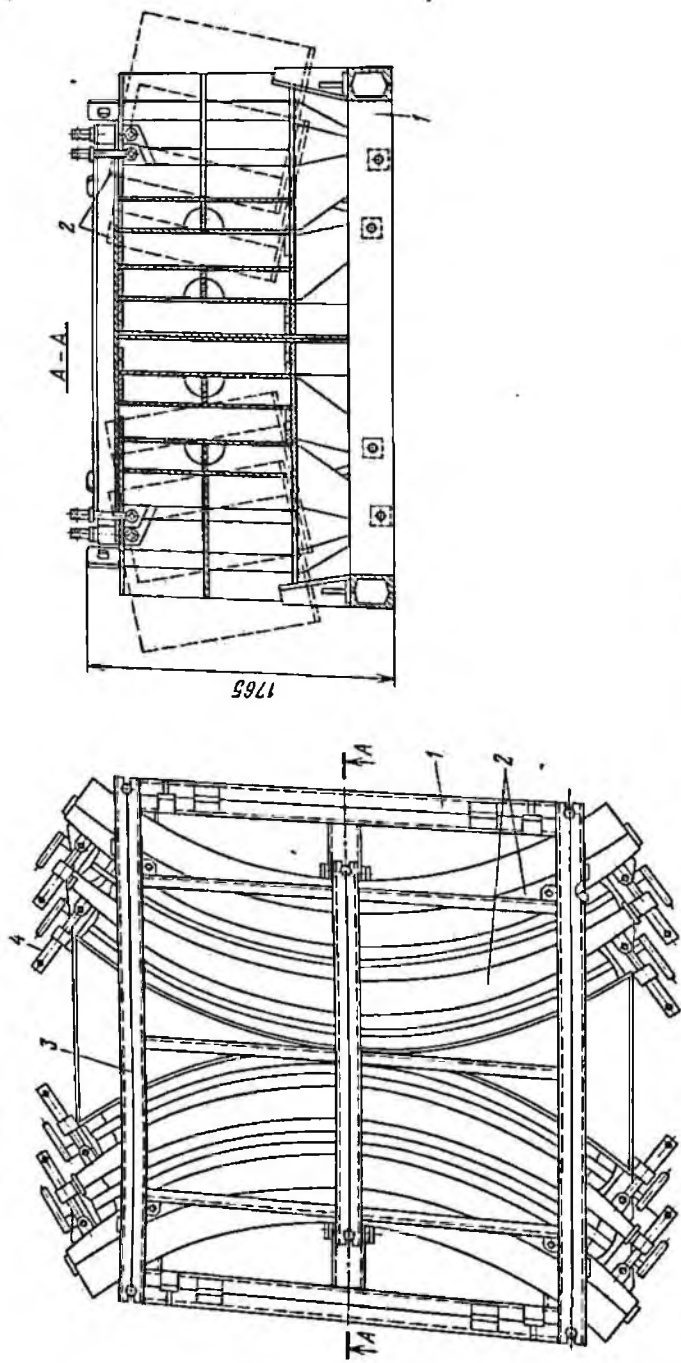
Кассетная форма для изготовления крупноблочной крепи КБМ-5:
